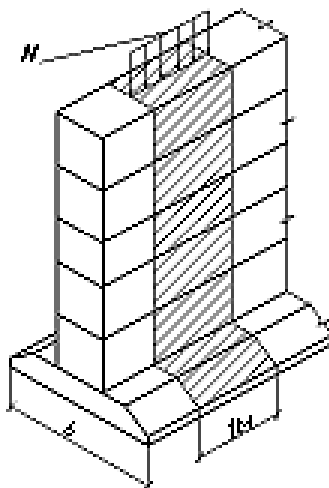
Схема сбора нагрузок на 1м длины фундамента
